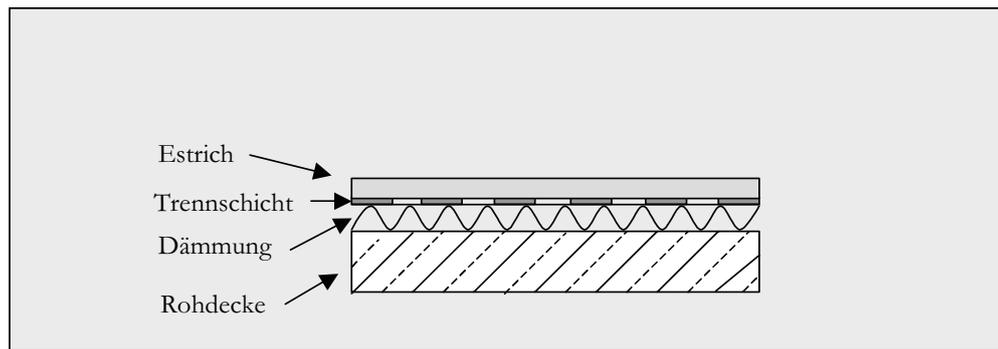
Prinzipieller Aufbau eines Estrichs mit Trennschicht und Dämmung (schwimmender Estrich)<sup>77</sup>
